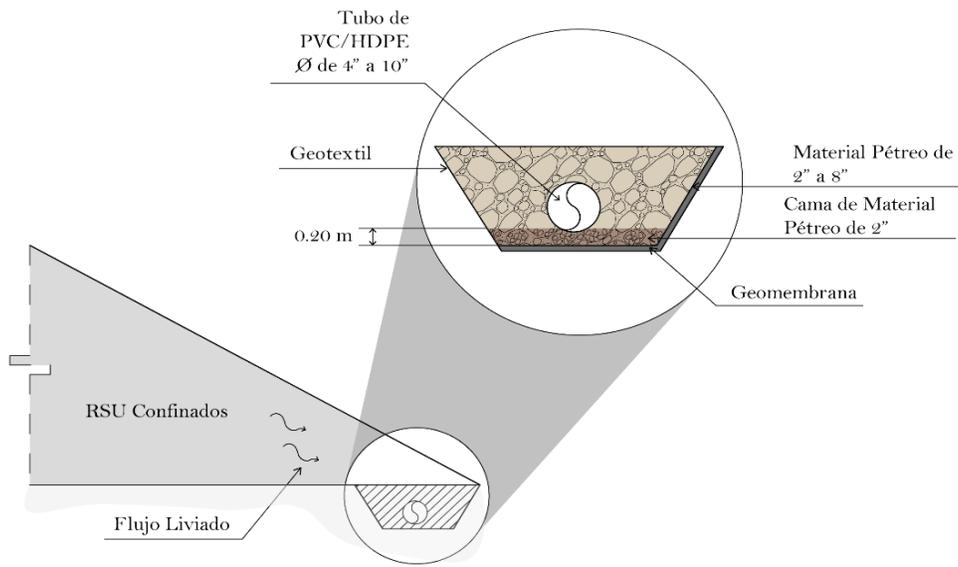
Diagrama de alternativa B de dren perimetral con tubo central y cubierta de geomembrana para la captación de lixiviado a pie de talud
